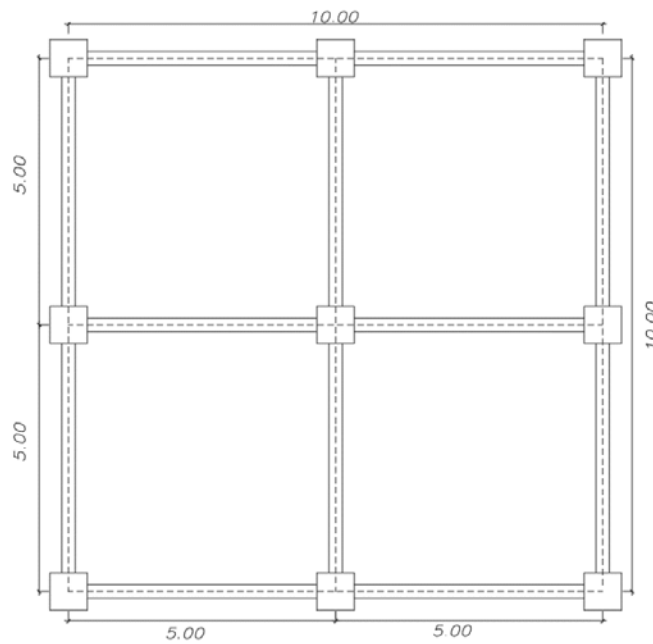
Caso 1 - Planta con vigas peraltadas en todos los bordes de los paños
